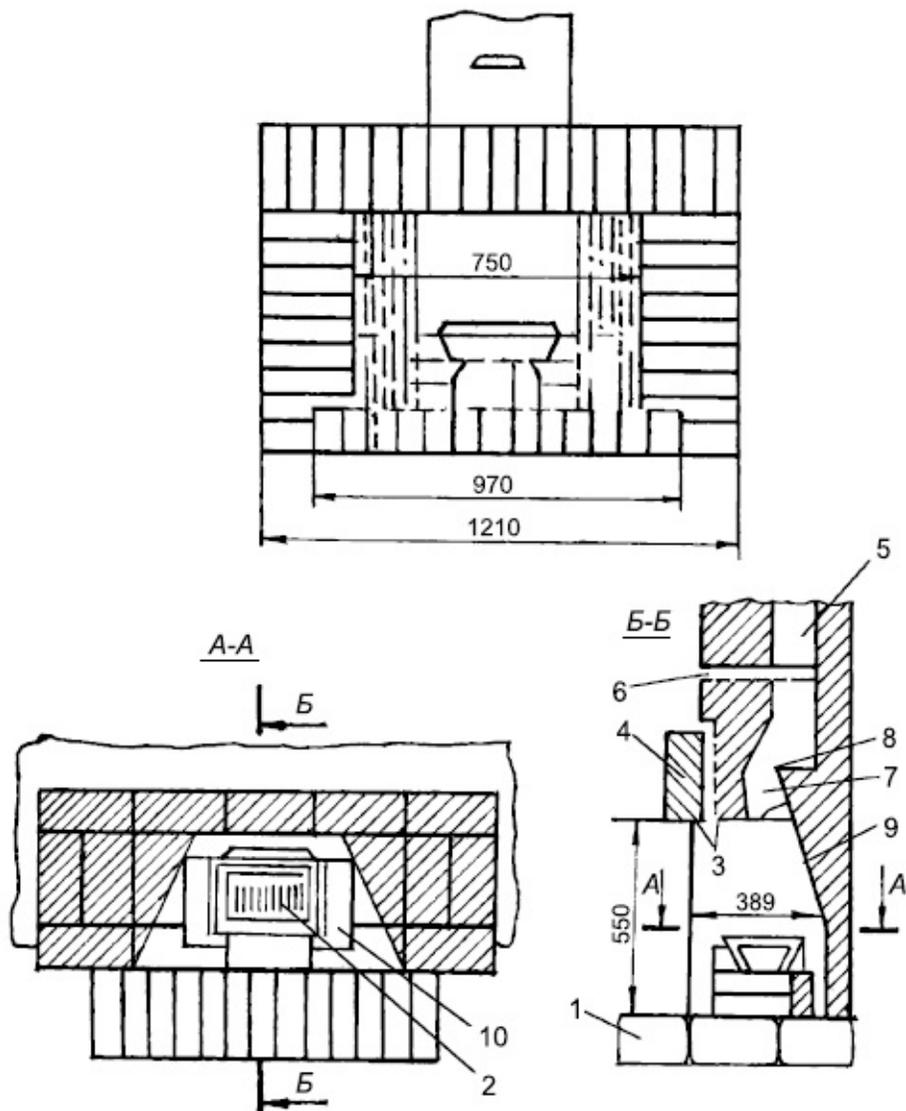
Камин с колосниковой решеткой-корзиной: 1 – площадка; 2 – колосниковая решетка; 3 – уголок; 4 – карниз; 5 – труба; 6 – задвижка; 7 – канал; 8 – порог; Камин, облицованный деревянными рейками
